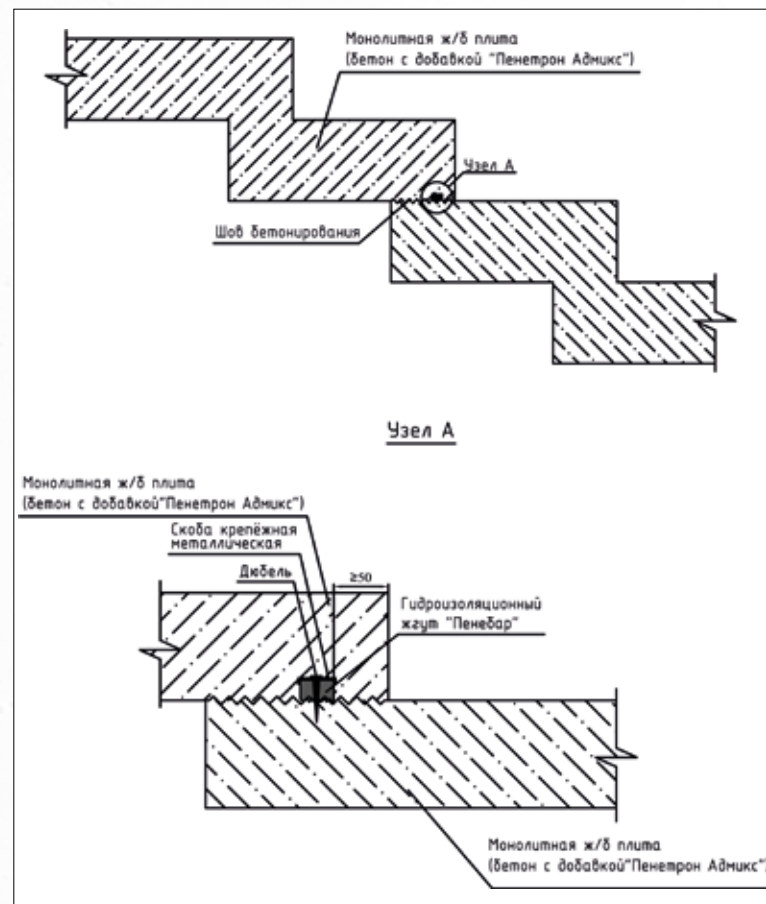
Схема устройства гидроизоляции ограждающих элементов конструкции и швов бетонирования в трибунных перекрытиях при их возведении
